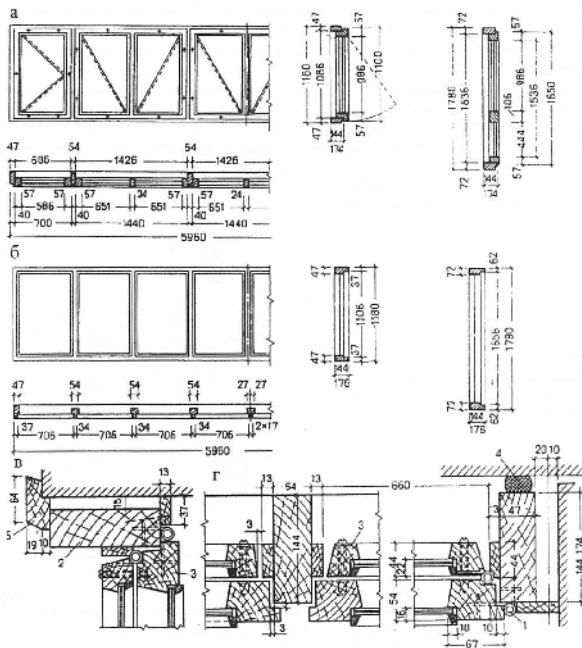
Деревянные оконные панели: а – с тремя фрамугами; б – глухая; в – вертикальный разрез в месте примыкания к стеновой панели; г – горизонтальный разрез в месте примыкания к колоше; 1 – петля; 2 – коробка; 3 – сваренный переплет; 4 – упругая прокладка; 5 – нащельник
